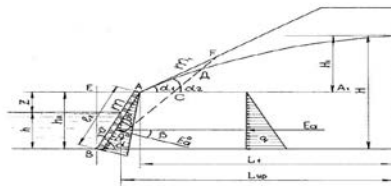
Схема к расчету давления грунта на водопроницаемую подпорную стенку
